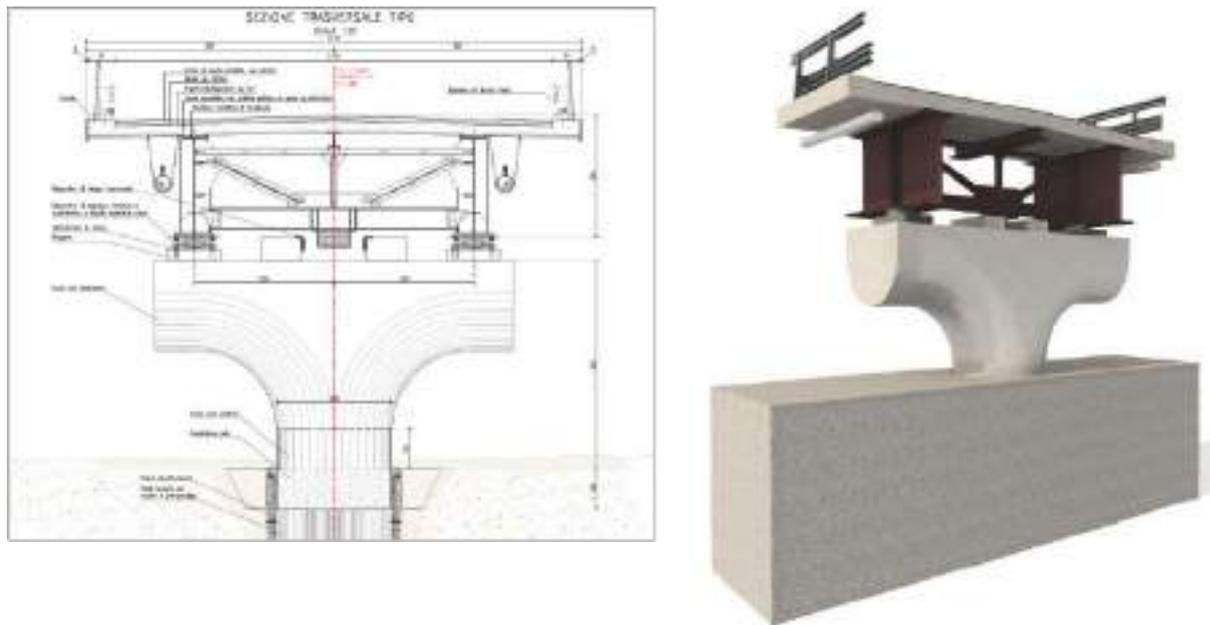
Carpenterie pila e impalcato: sezione e vista 3D.
